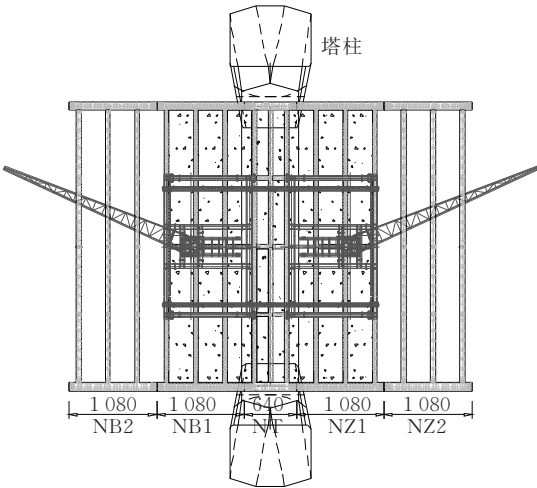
40 t步履式全回转吊机安装平面图(单位:cm)
